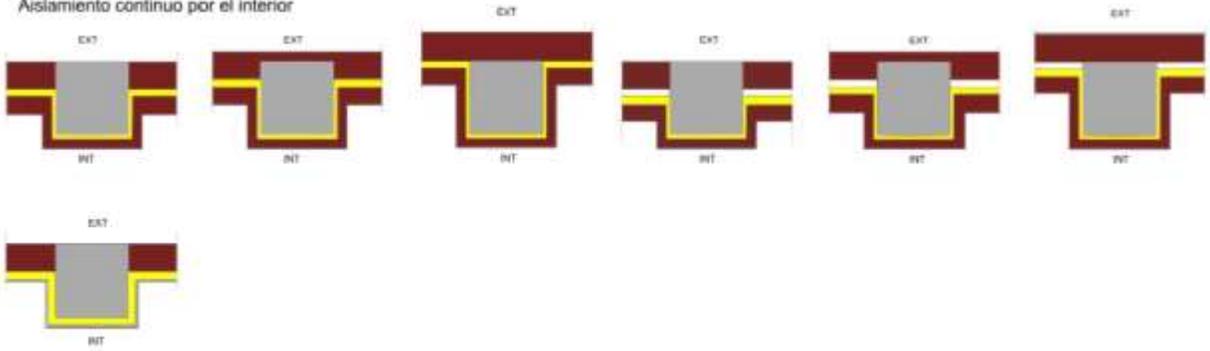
Columnas con continuidad del aislamiento de fachada.
